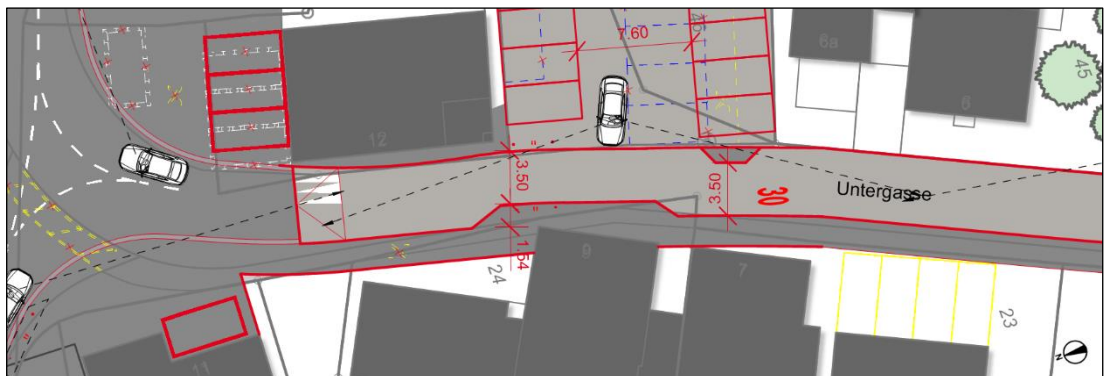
Variante Strassenführung kurzfristig mit bestehenden Gebäuden
